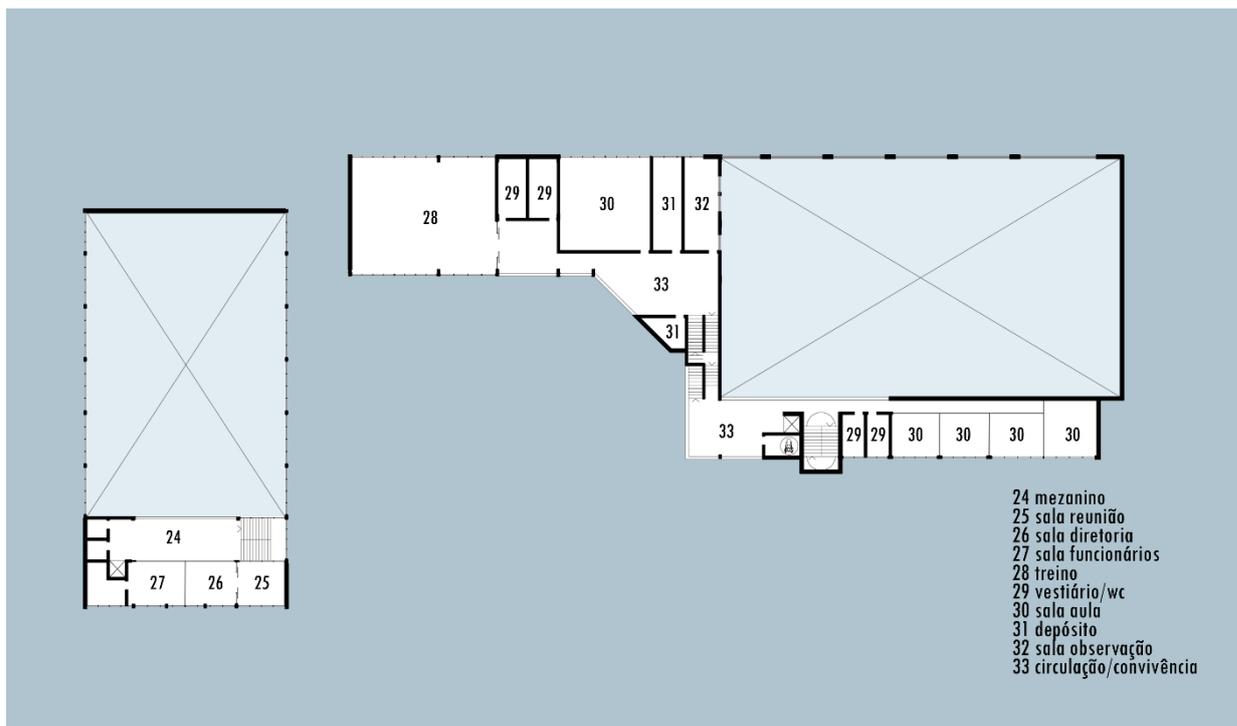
Planta Baixa Reabilitada - 1º PAVIMENTO. Fonte: produzido pela Autora.
